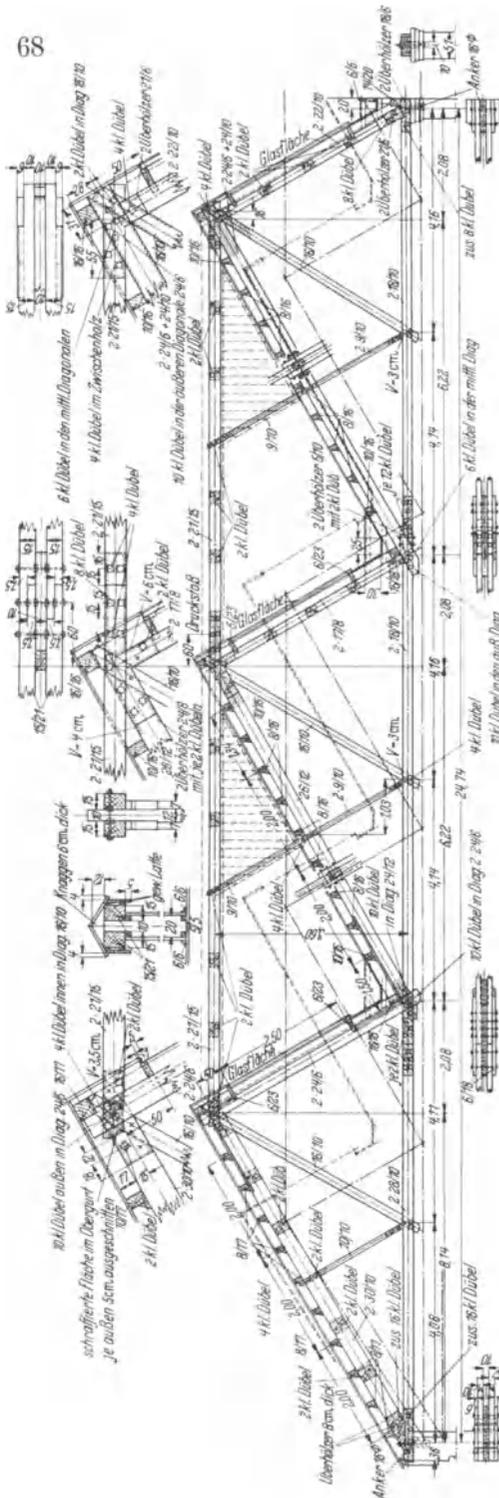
Shedhalle für eine Kunstseidefabrik.
